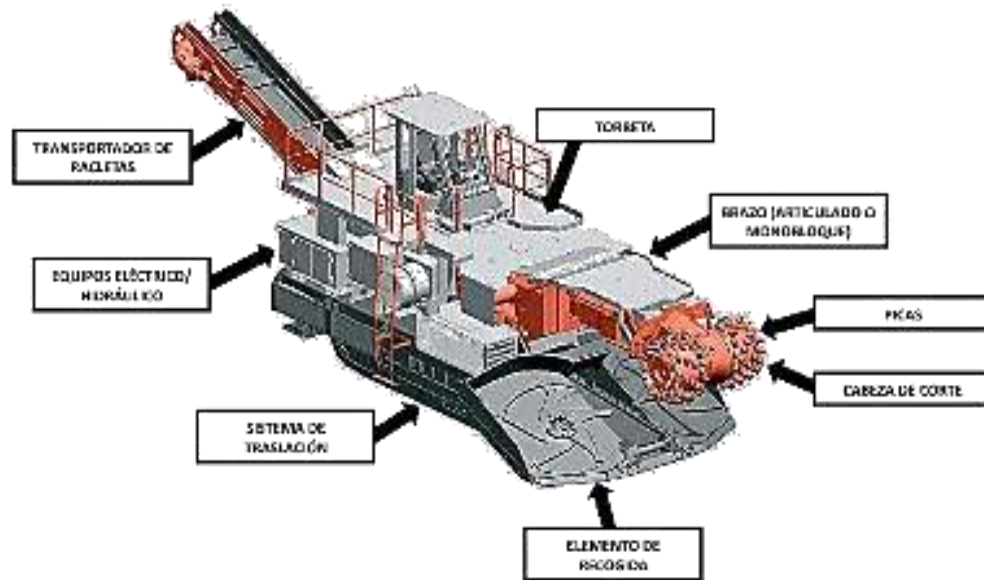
Máquina Rozadora de Ataque Puntual 6.6M/MT720
